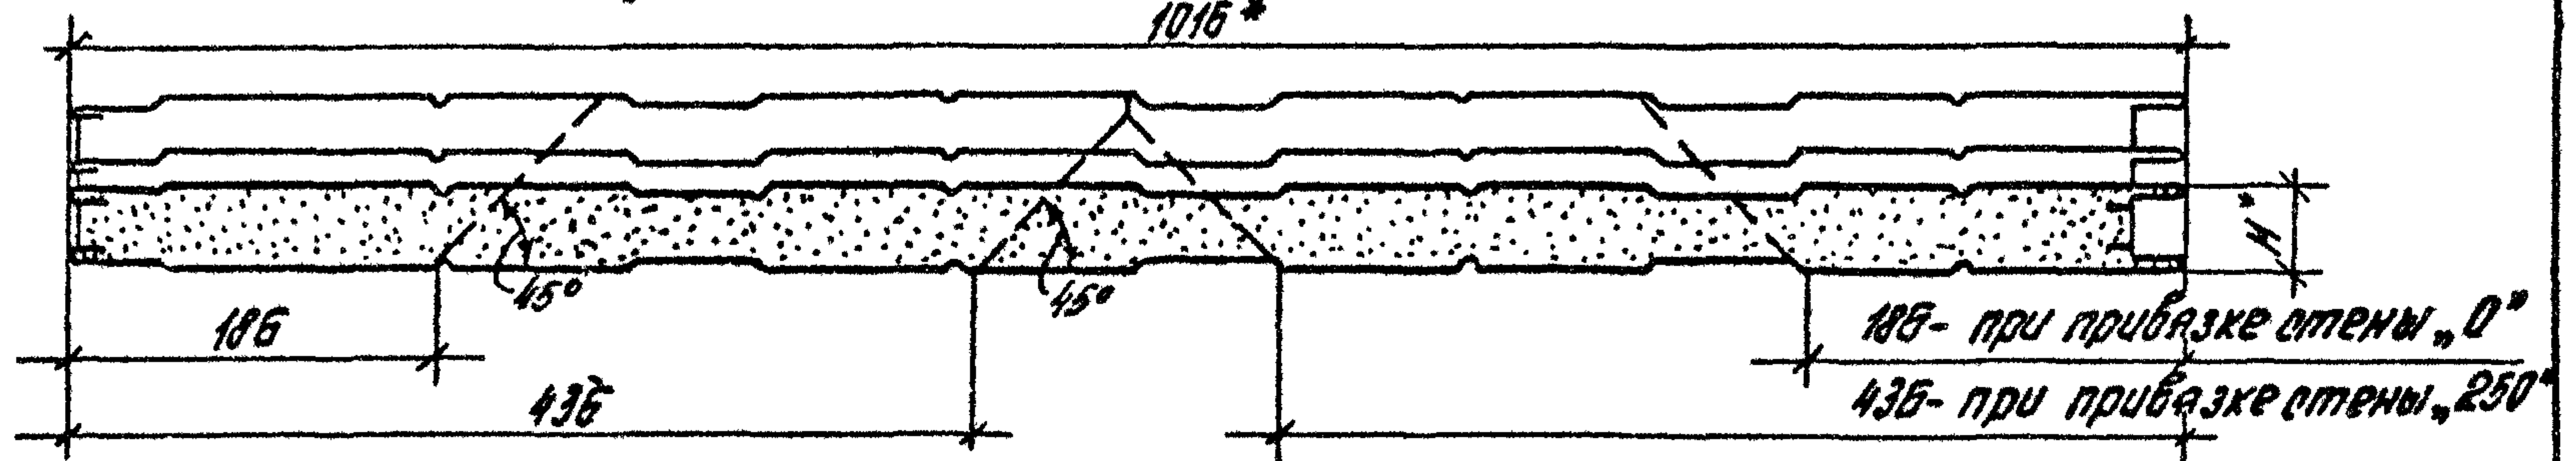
для углов зданий подлежащих строительству в сейсмических районах
